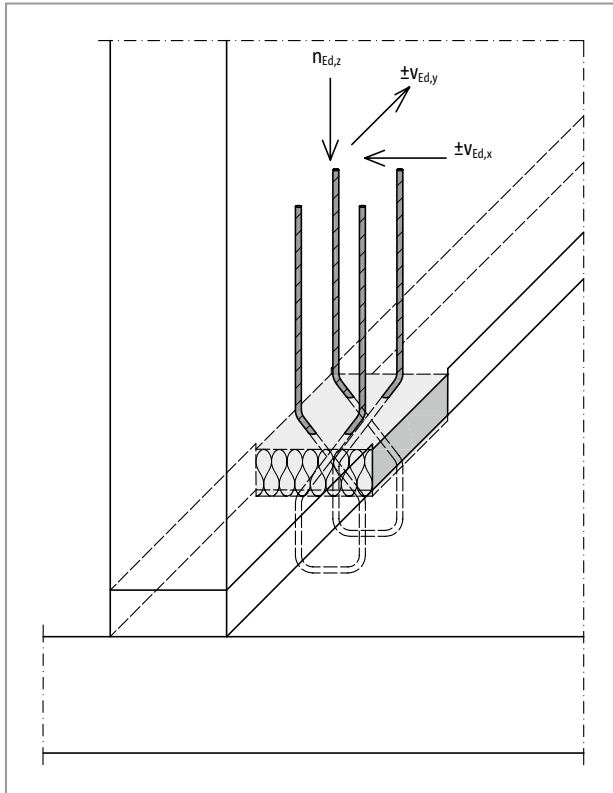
Schöck Sconnex® type W-N-VH: Static system
